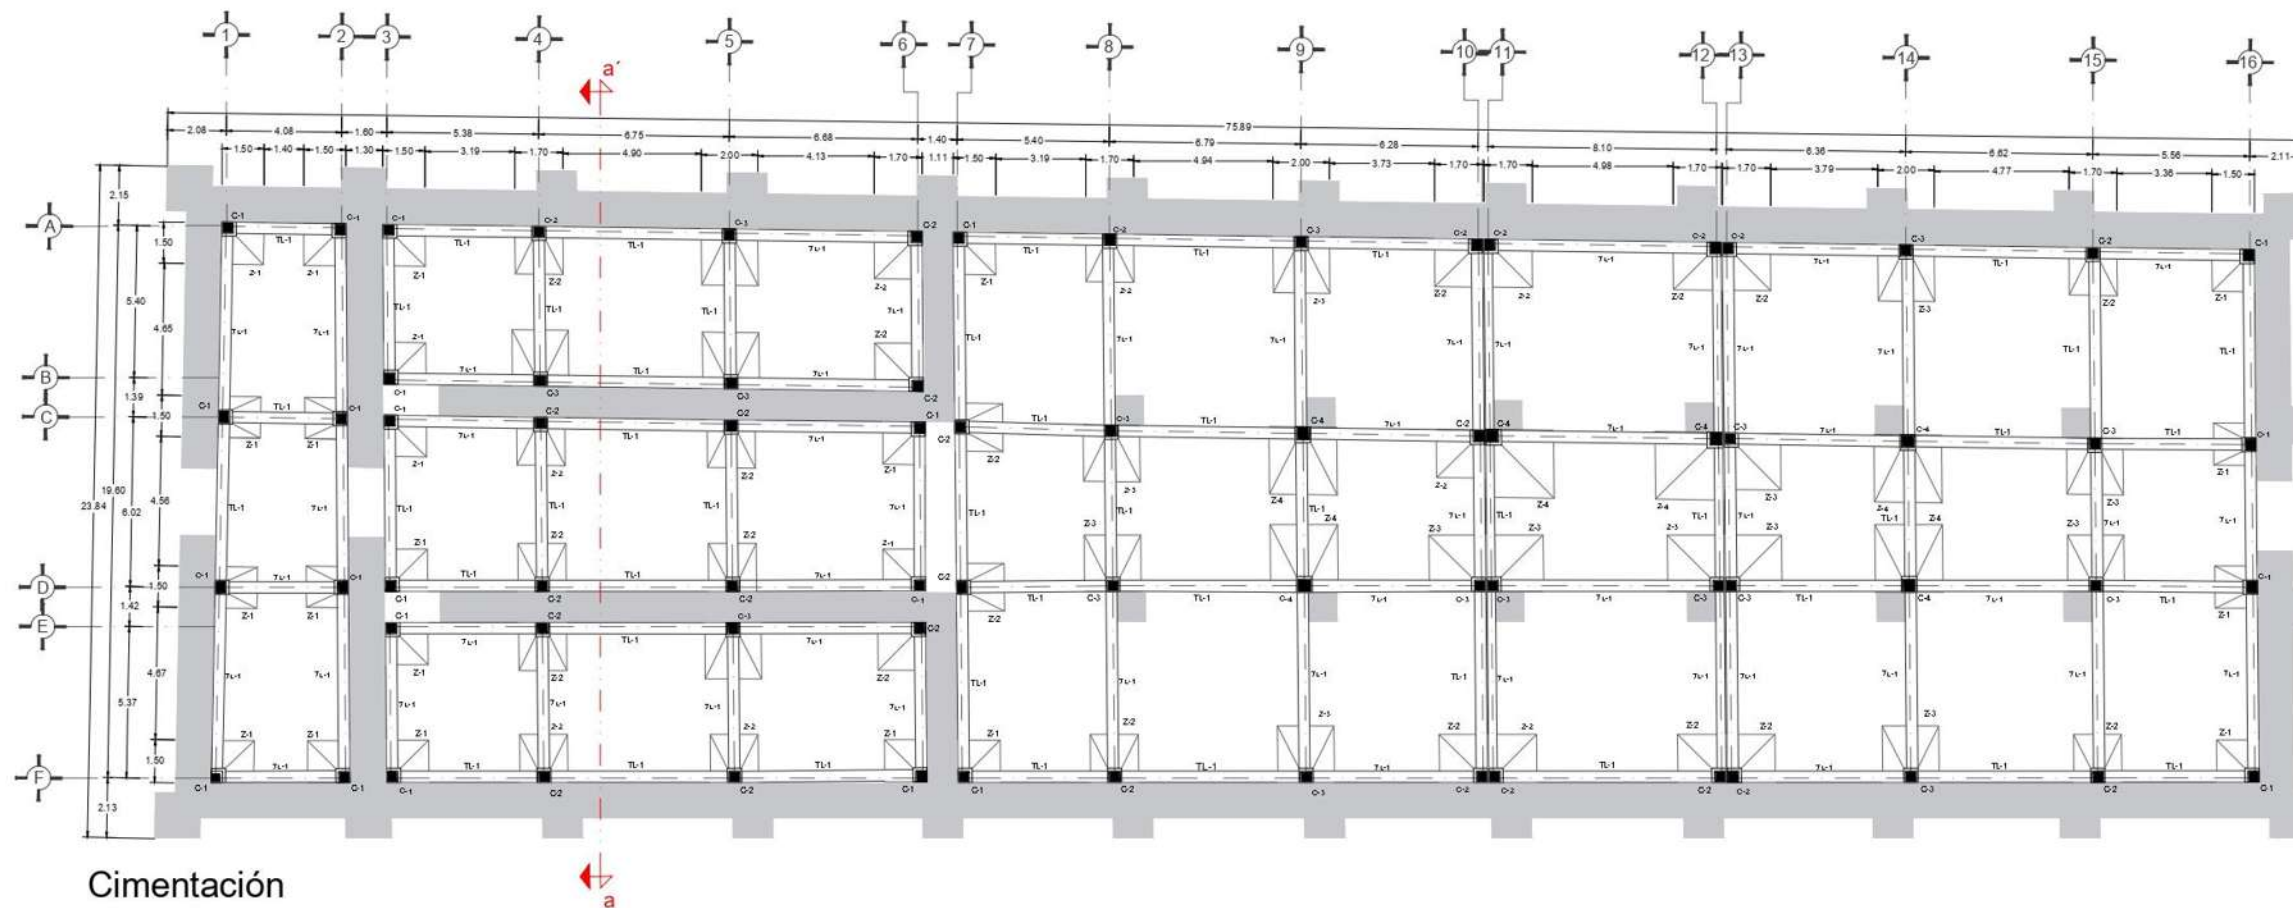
Plano de cimentación. Fuente: Elaboración propia.
